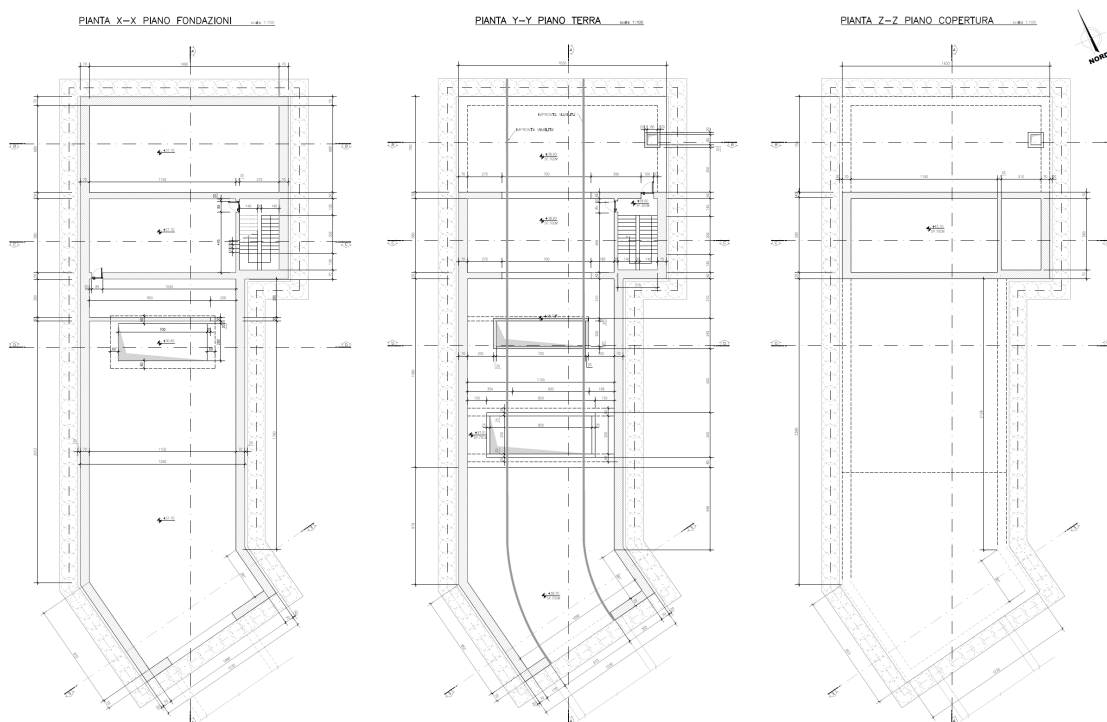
Rampa di accesso alla galleria di sfollamento, piante
